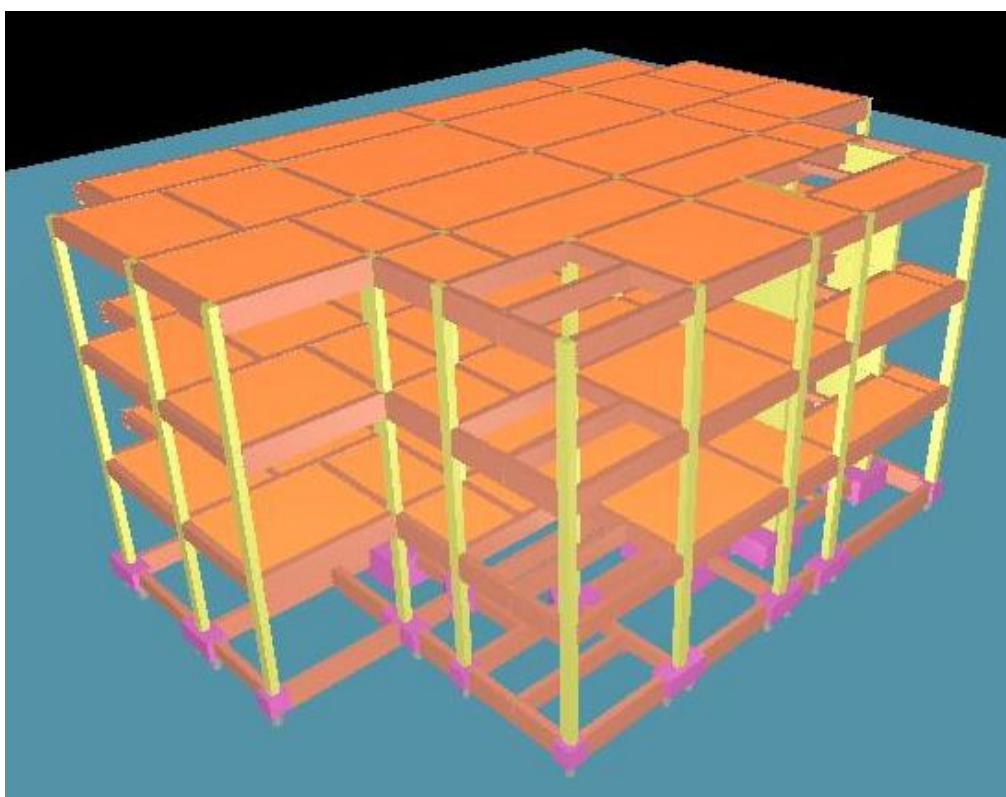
Forma da Fundação Até o Terceiro Pavimento
